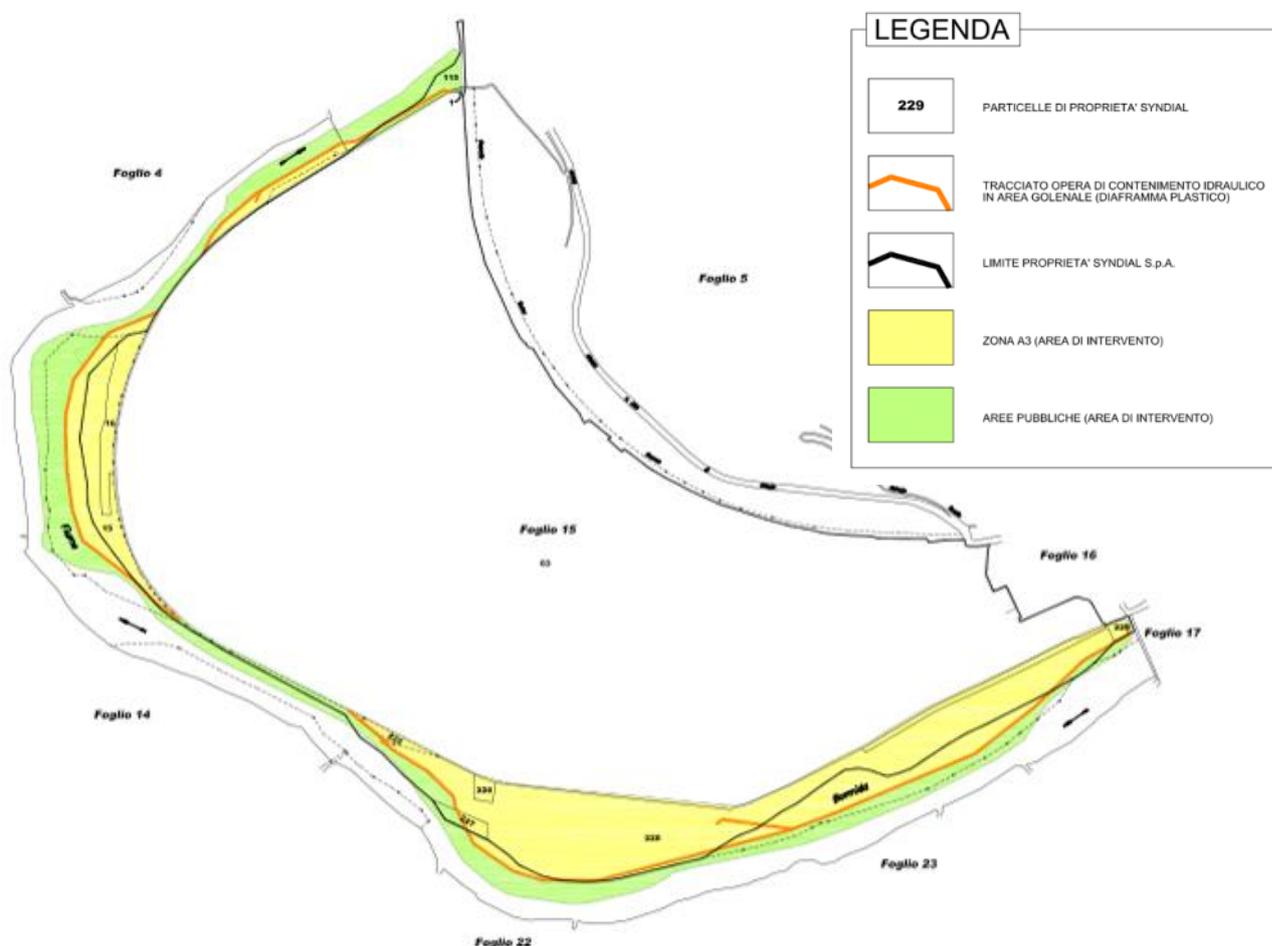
Estratto da planimetria catastale dello stabilimento di Cengio con ubicazione delle aree di intervento per la bonifica delle aree Golenali (tratto da Progetto Esecutivo di Bonifica delle Aree Golenali - Zona A3 e Aree Pubbliche – Rel SPC. 03-BE-E-95270 Tav. 03-BL-A—95281 – Snamprogetti)
